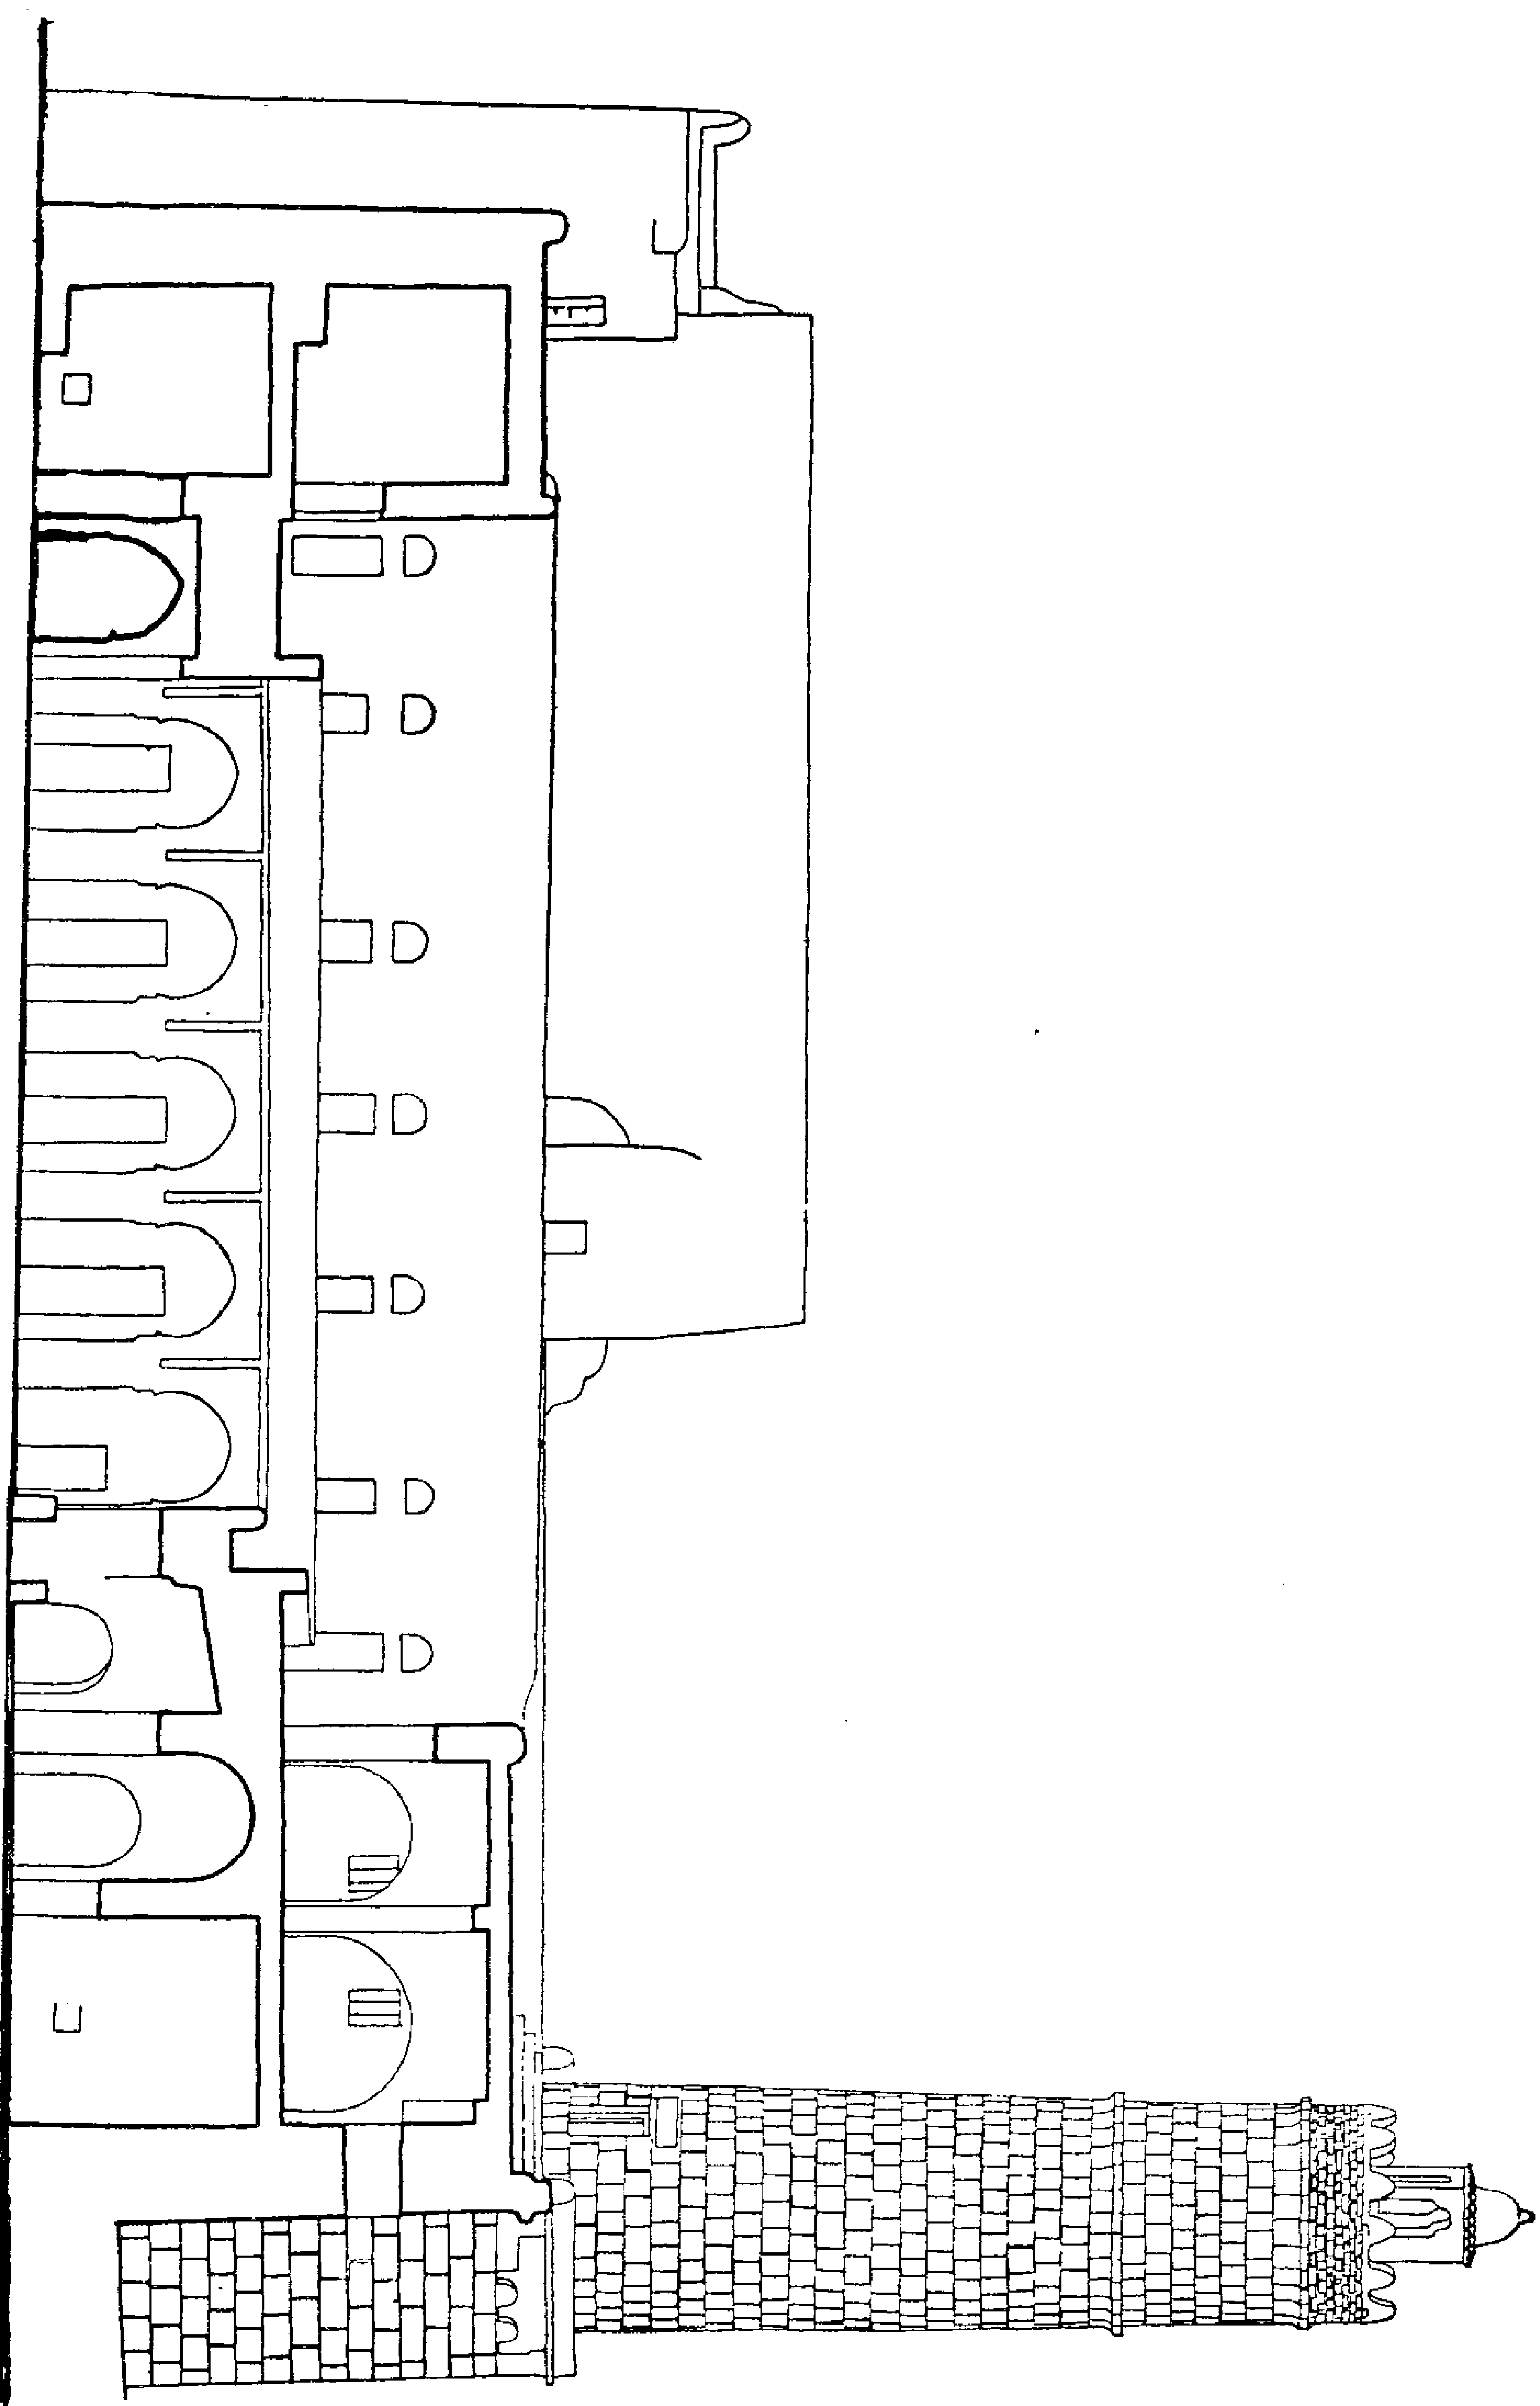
رباط مسجدة - مخطط 1 - 1 -
